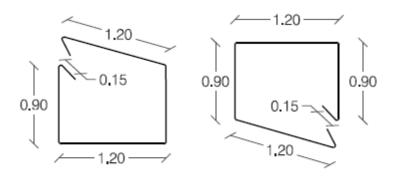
DETALLE ESTRIBO DIAGONAL VASTAGO ESTRIBO No. 3
